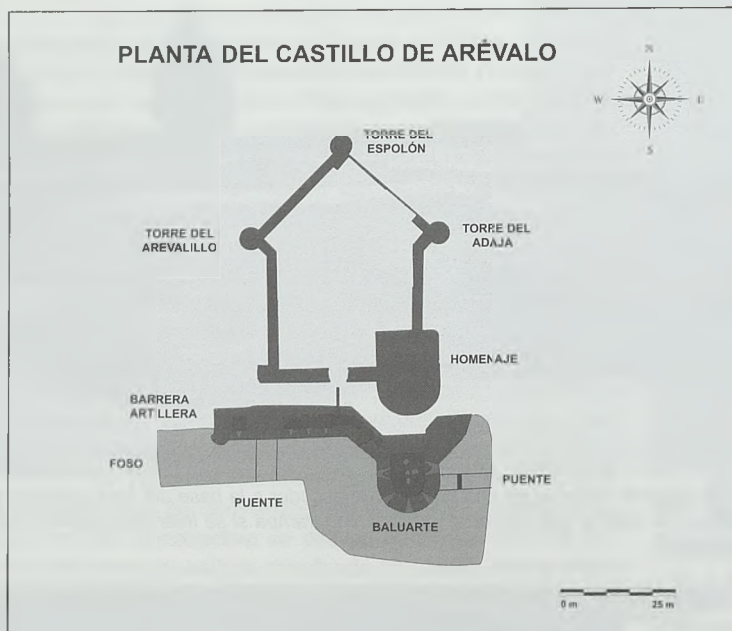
Planta actual del castillo con los hallazgos de la excavación arqueológica de 2007
